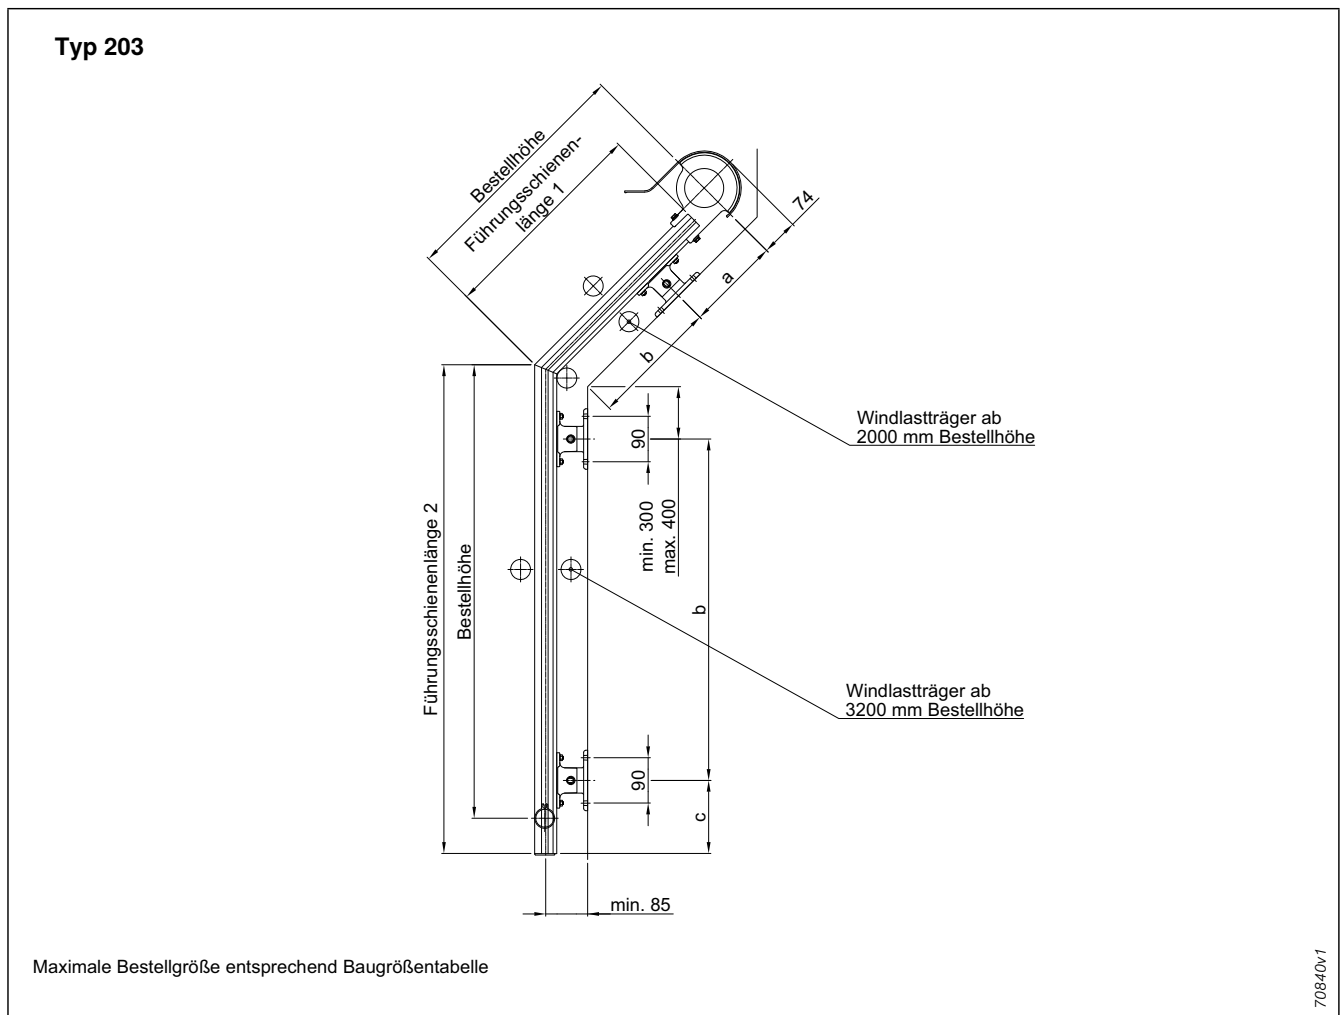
Führungsschienenhalter – Abstände Typ 203
